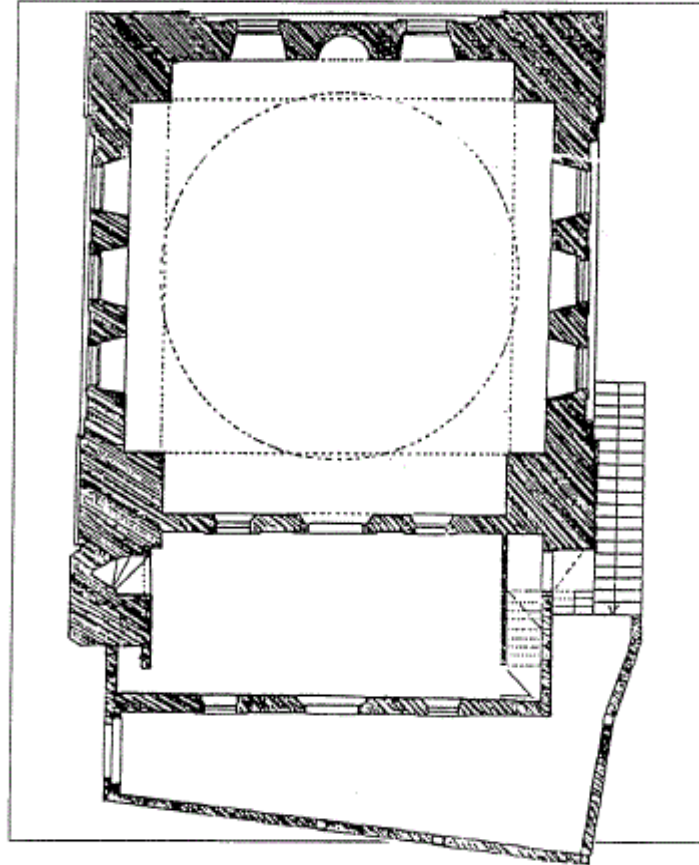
مكرر) مسقط أفقي لتربة حاجي سلطان في بورصة (عن: Wilde).
